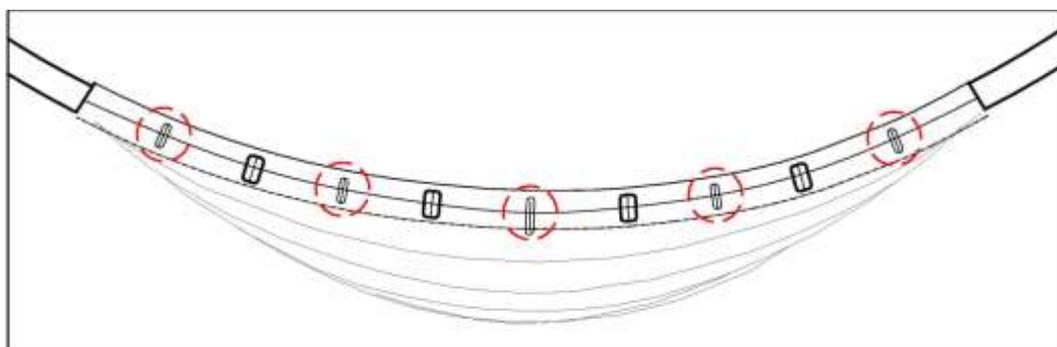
Planimetria con indicazione delle pile da demolire (cerchiate)
